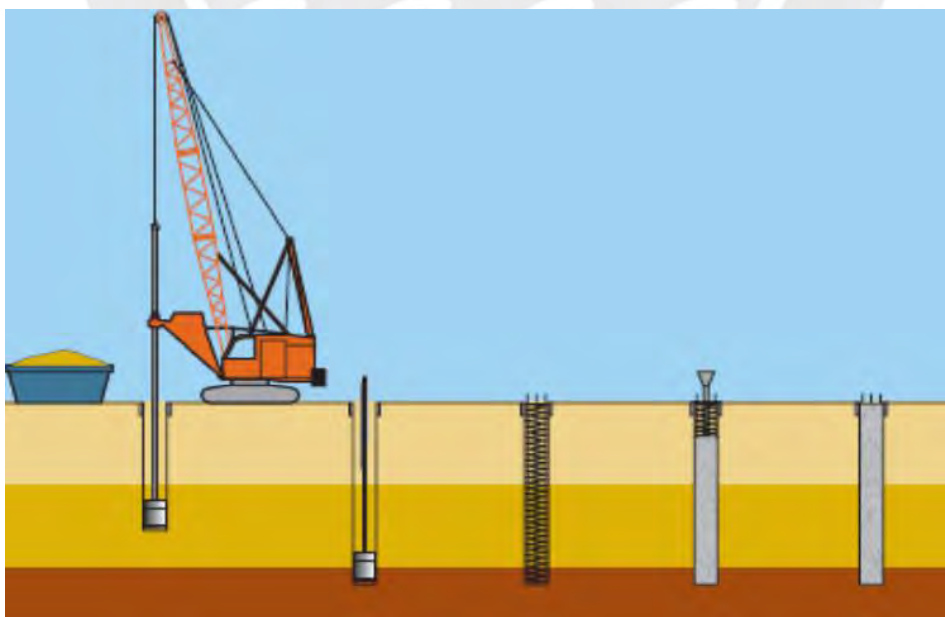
Proceso constructivo pilotes utilizando lodo bentonítico. (Fuente: Pilotes Terratest. 2001)
